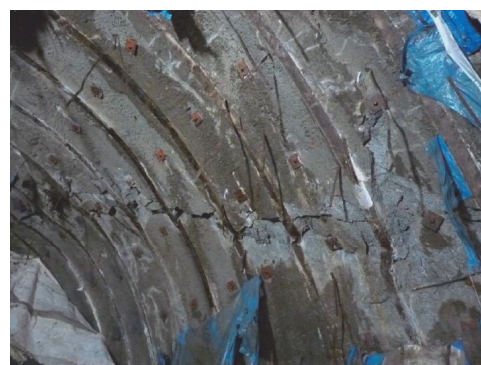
スパン 167 付近の支保工の状態 (覆工撤去後)²⁾
